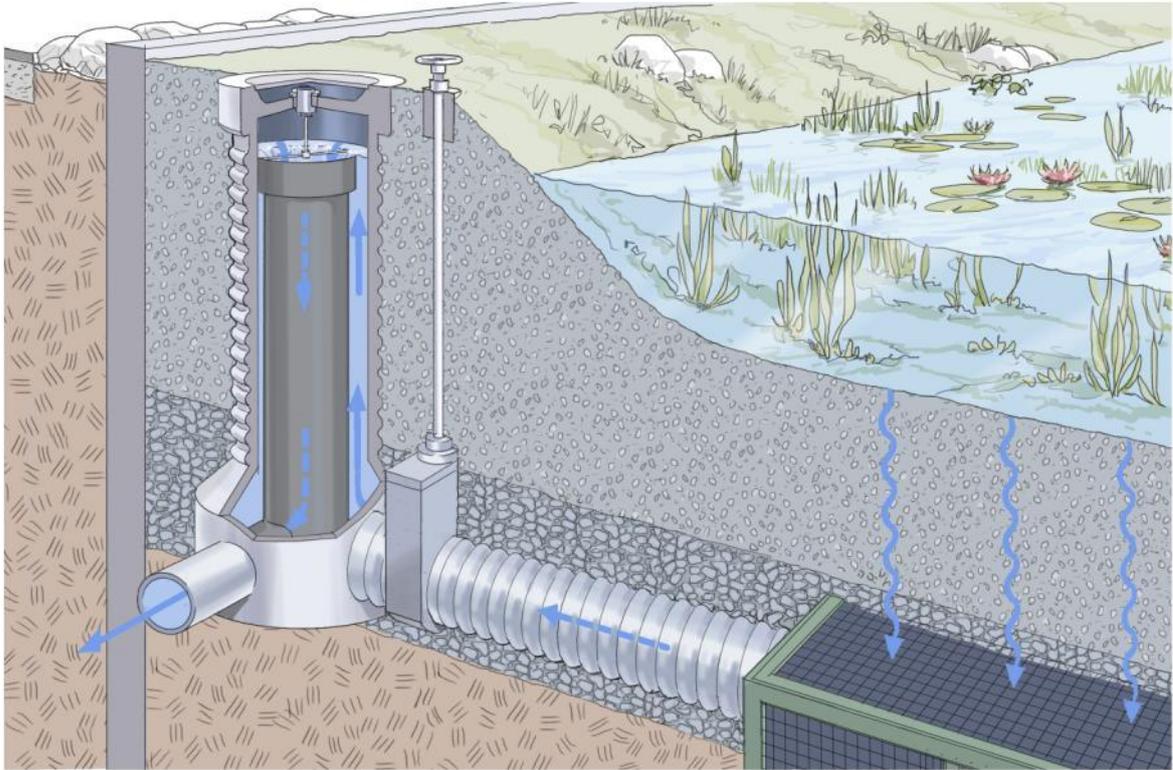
Schematische Darstellung des Aufbaus eines Bodenfilters. Benetzte Oberfläche mit Wasserpflanzenbestand, Kalksplittschicht, Rigolenkasten, Sammelleitung und Ableitungsschacht.
